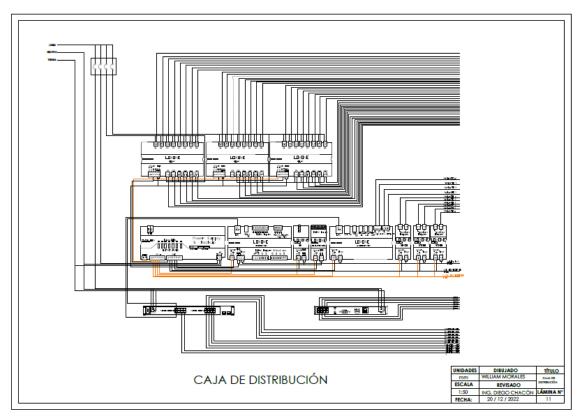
Plano de la caja de distribución de los elementos centrales.
